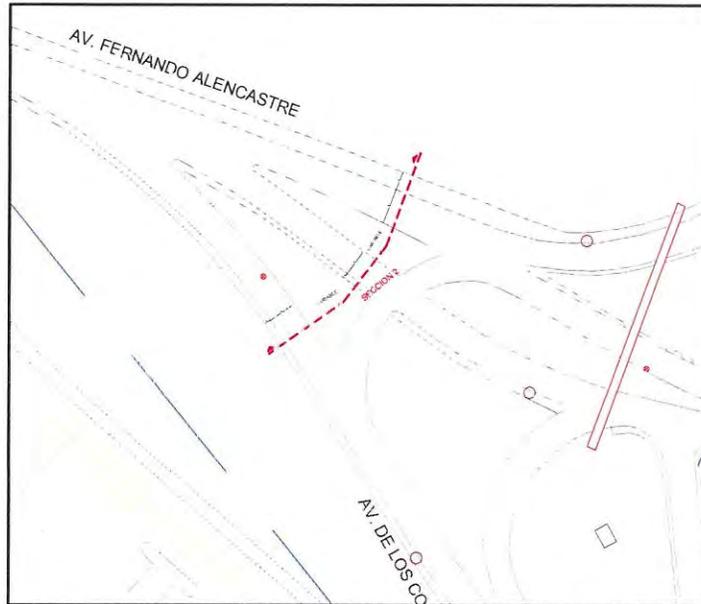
Localización de sección Av. Fernando Alencastre. Fuente PROYECO.
